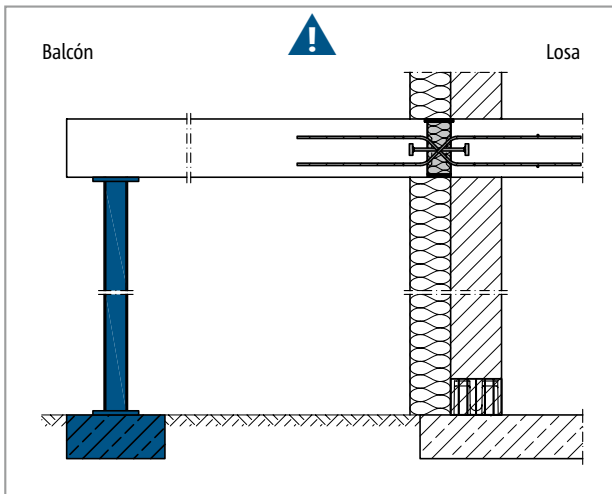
Schöck Isokorb® T tipo Q-P-VV: Se requiere apuntalamiento continuo
